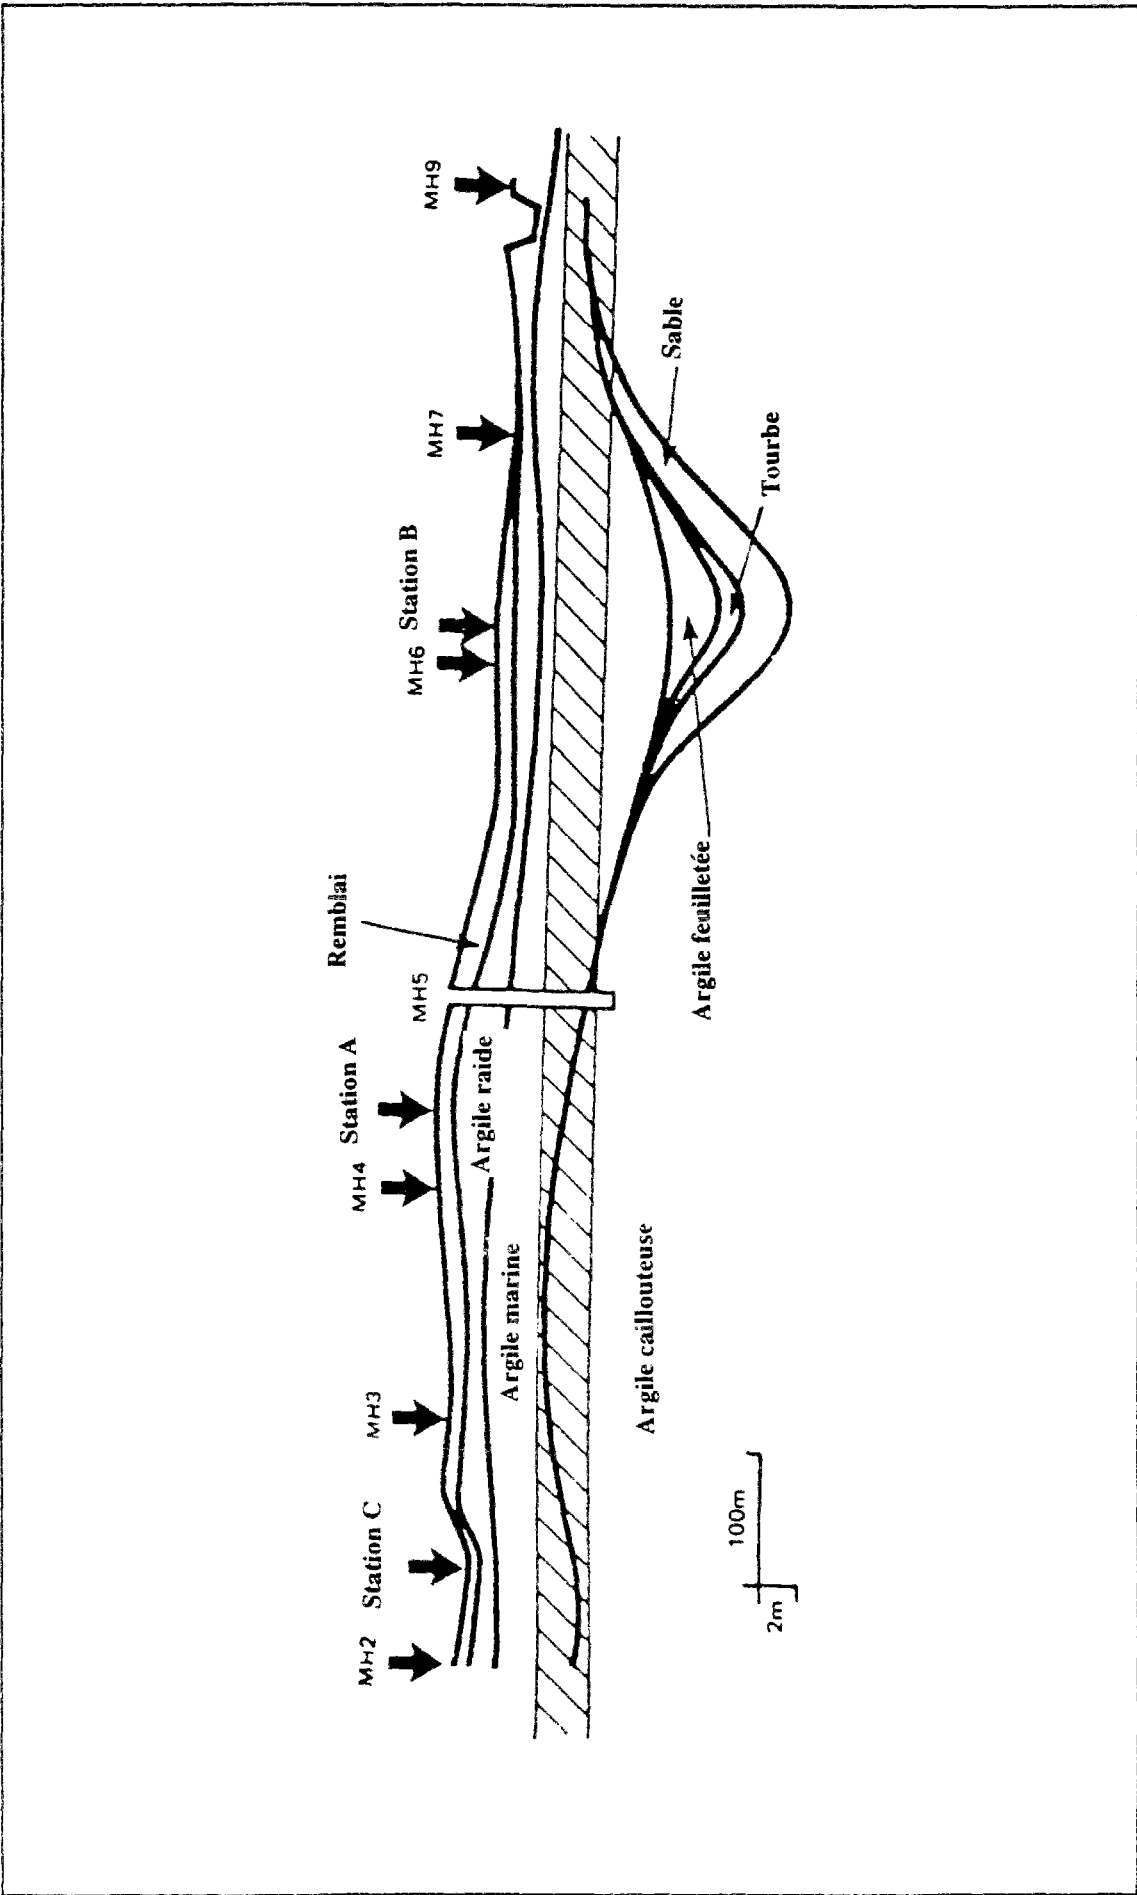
Profil géotechnique le long du tracé du tunnel de Grimsby.
